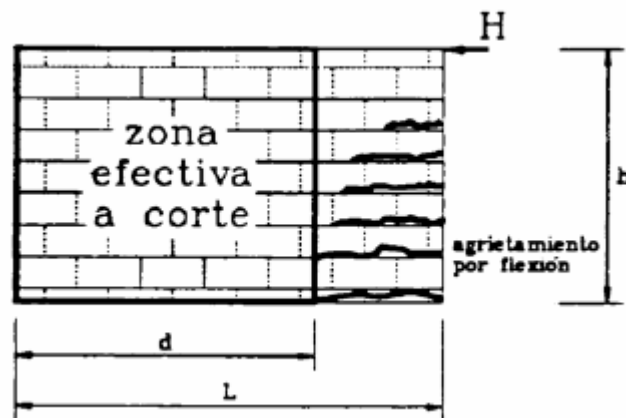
Zona efectiva a corte de muros de mampostería no reforzado
